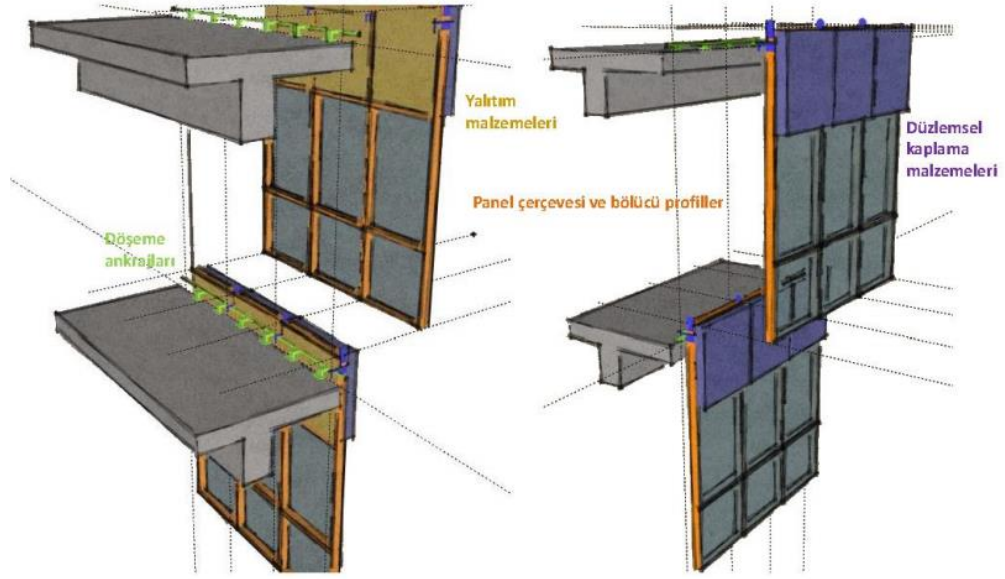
Çubuk sistem elemanları montaj detayı [29]
